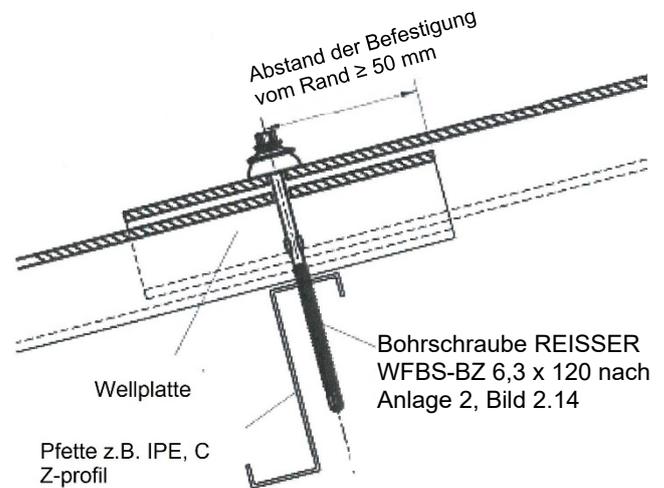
Anordnung der Befestigung auf Stahl-Unterkonstruktionen mit Bohrschrauben
